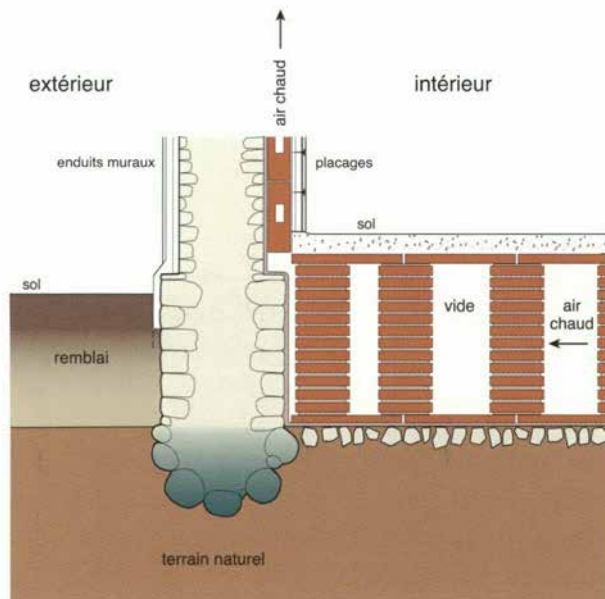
Détail de la construction du mur d'un local chauffé par hypocauste, correspondant à la variante "a" de la fig. 31; en noir: dalles et pilettes de terre cuite.
